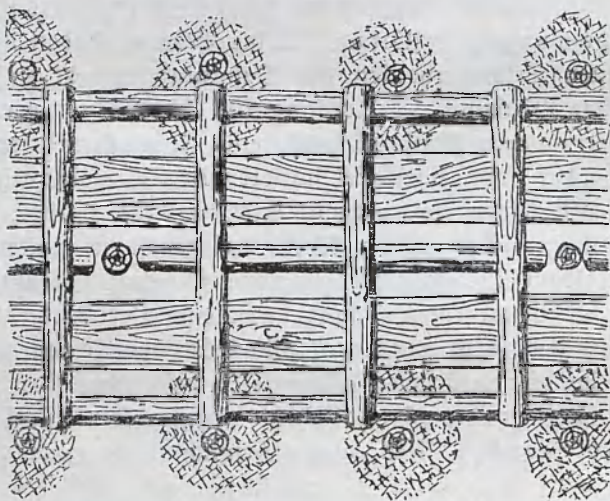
Grundriß der Holzkonstruktion. 1 : 50.
